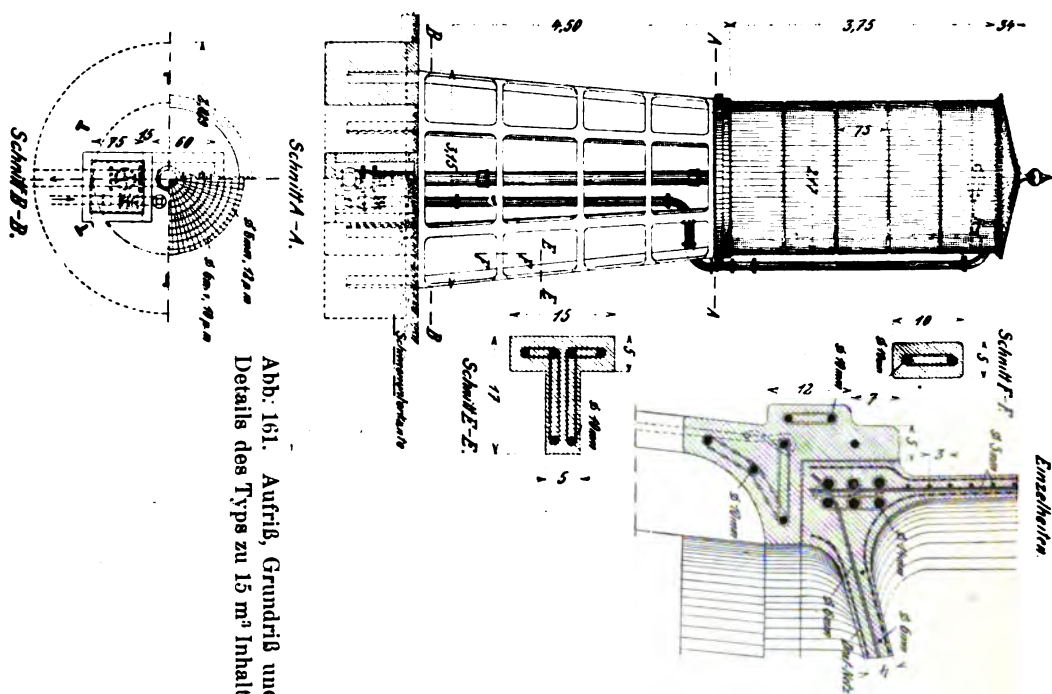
Aufriß, Grundriß und Details des Typs zu 15 m³ Inhalt.
